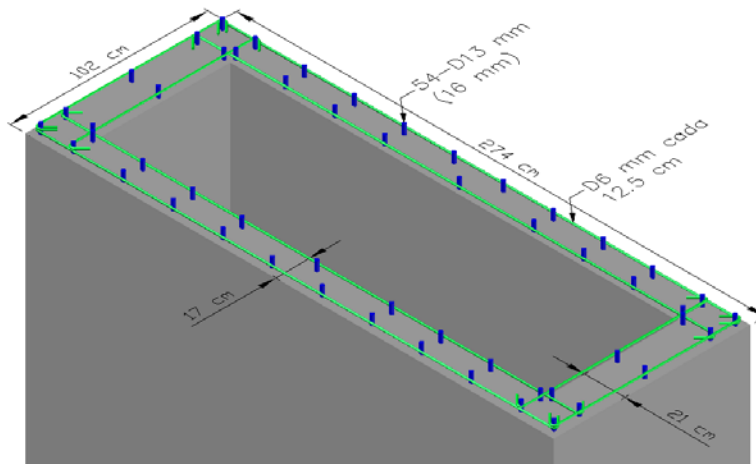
Sección transversal y configuración del refuerzo estudiado por Pinto et al. (2003)
